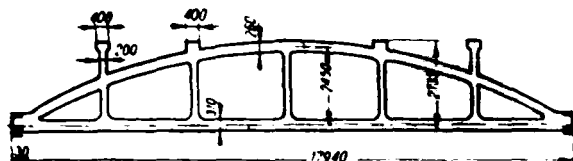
Безраскосная ферма пролетом 18 м для плоской кровли
